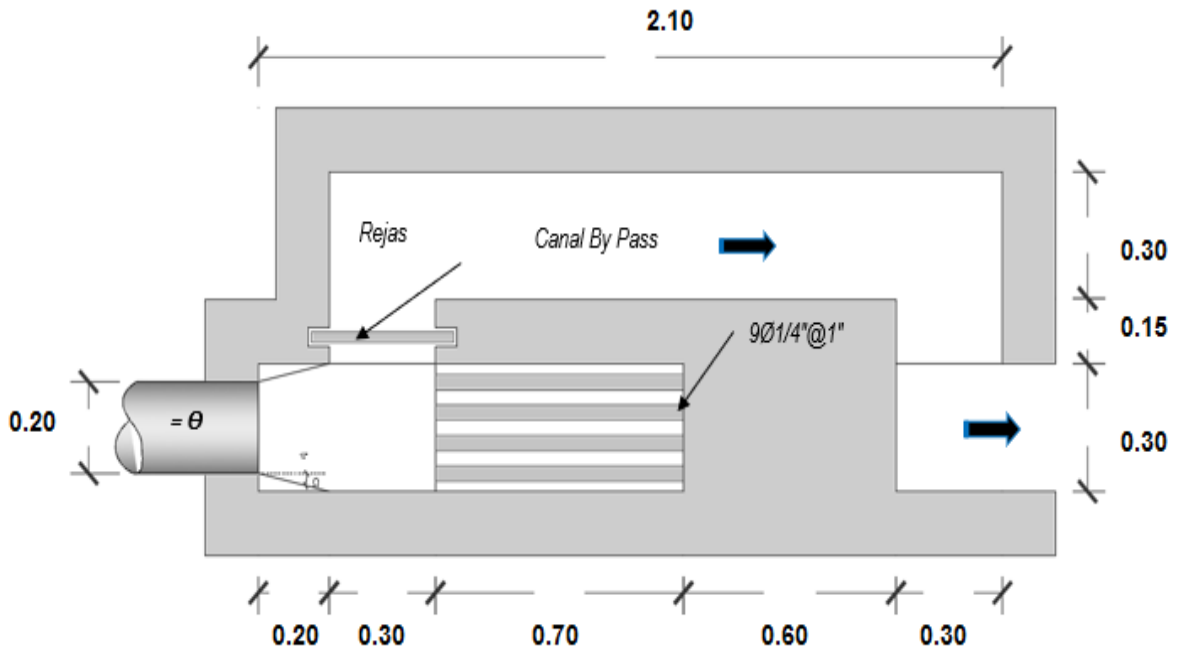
Medidas de la estructura vista en planta de la cámara de rejillas
